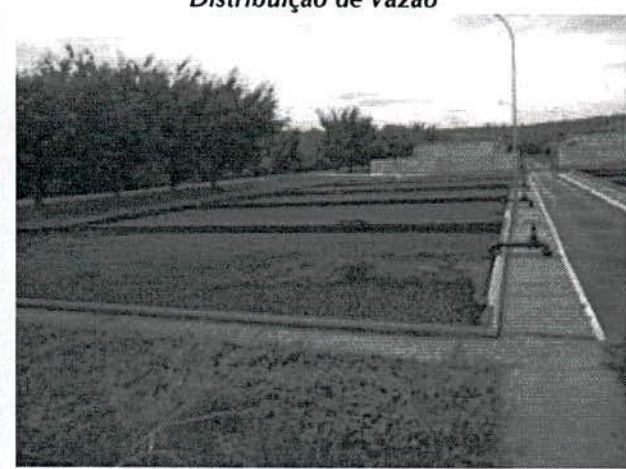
ETE Ipanema – Leitões de Secagem de Lodo
